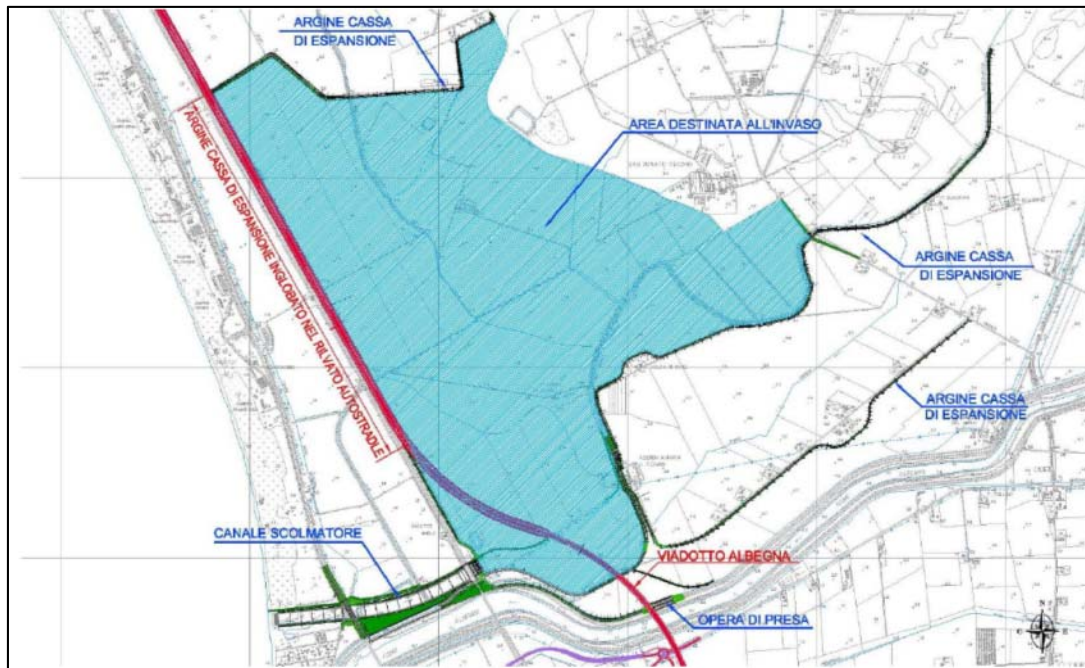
Planimetria area cassa di espansione Campo Regio
